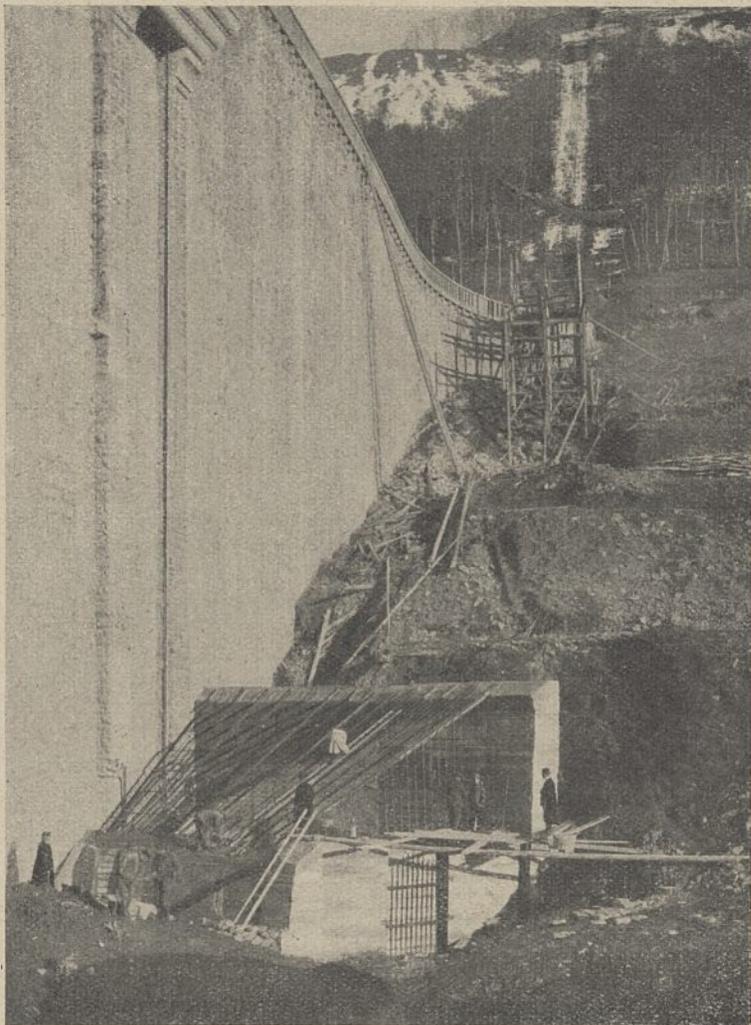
Rechter Grundablass-Einlauf und Bremsberg vom Steinbruch am 24. November 1923.
